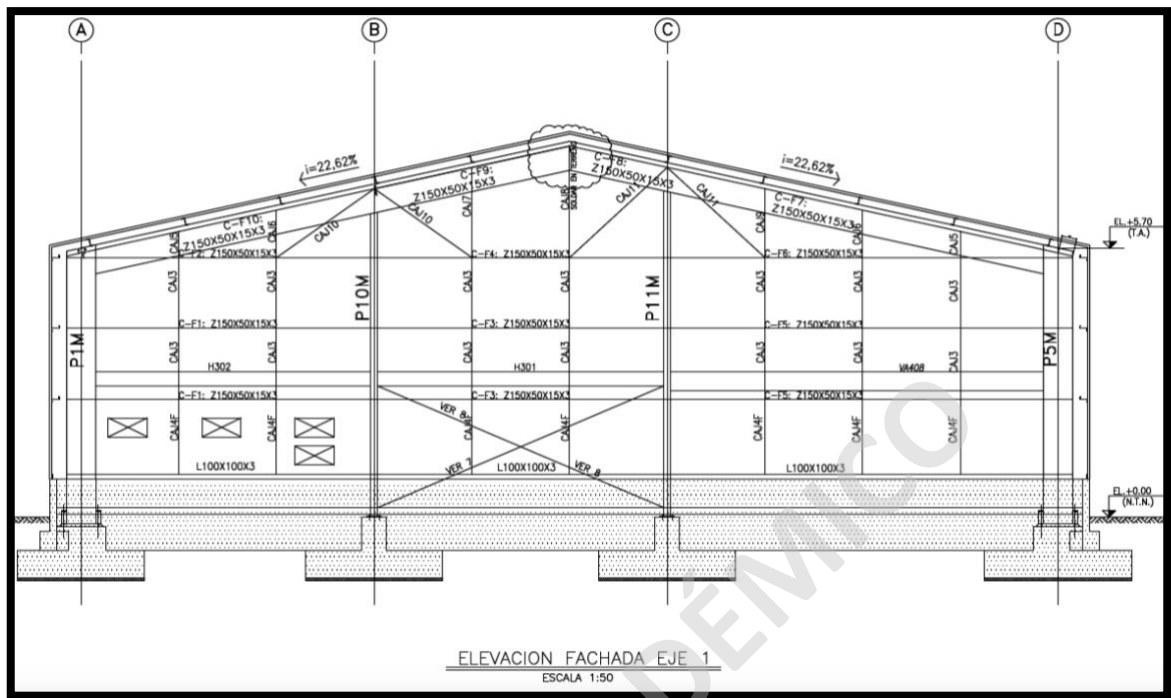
Elevación de Eje 1 Colgadores ODR Ingeniería y Montaje.
